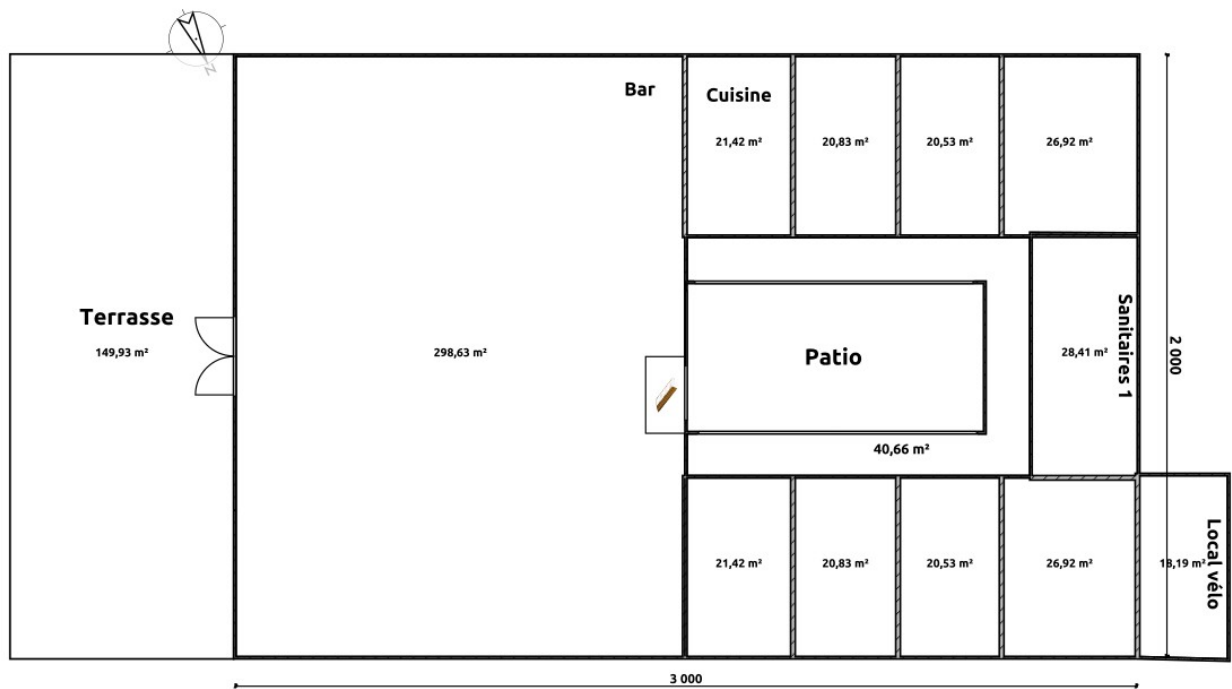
Eléments de proposition pour le rez-de-chaussée. L'espace de 300 m² serait reconfigurable (division en deux ou en quatre). L'espace sanitaire permettrait d'héberger douches et toilettes.
